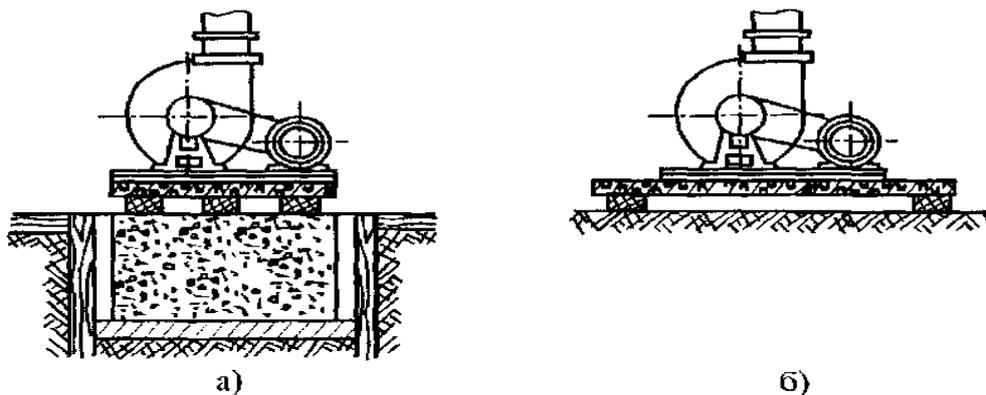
Установка агрегатов на виброгасящем оборудовании:
